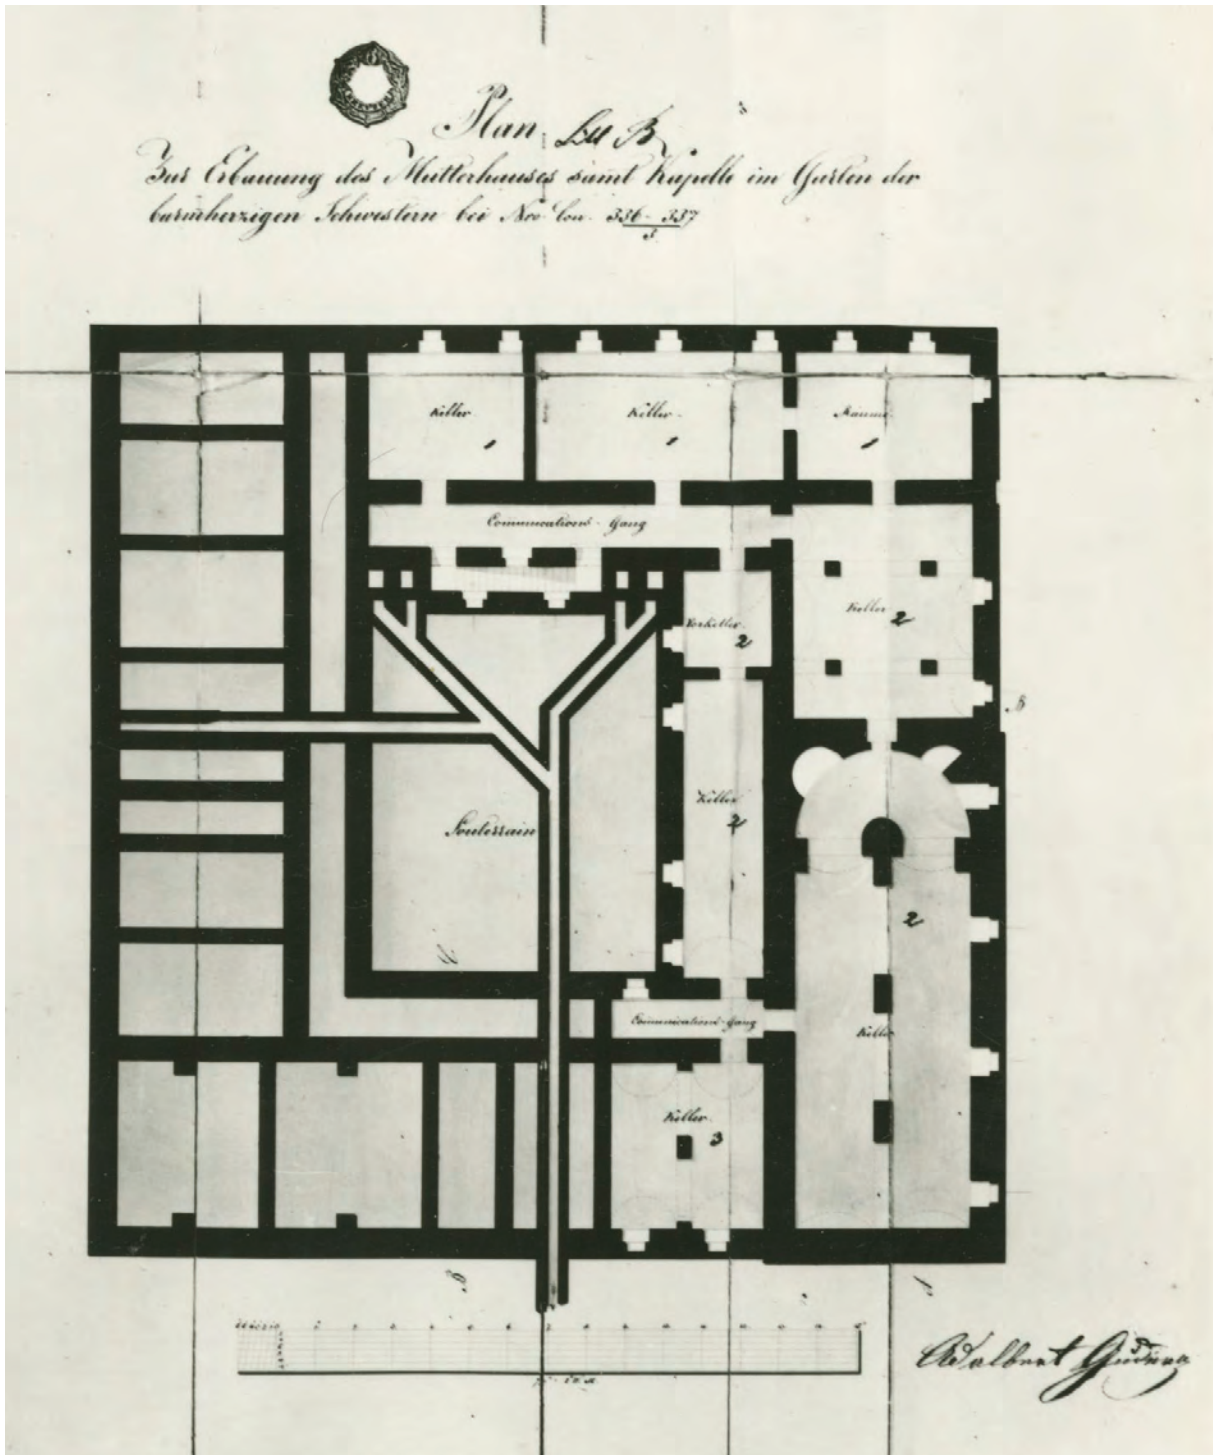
Plan zur Erbauung des Mutterhauses samt Kapelle im Garten der Barmherzigen Schwestern bei Nr. 336 und 337, Grundriss, Untergeschoss, Architekt Adalbert Gudera, 1851
